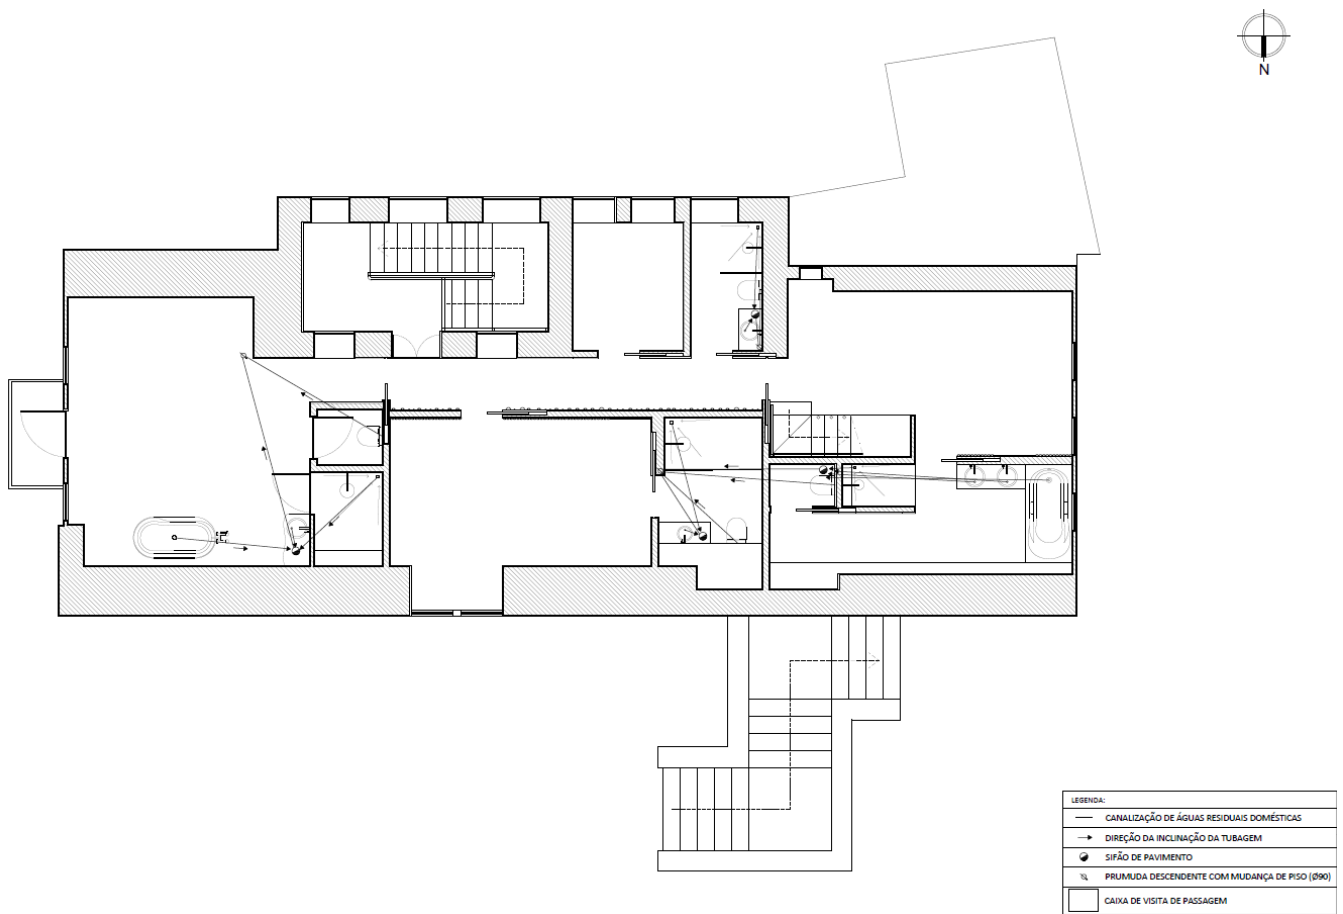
Planta de Esgotos, Alojamento Loureiro, Piso 1.
